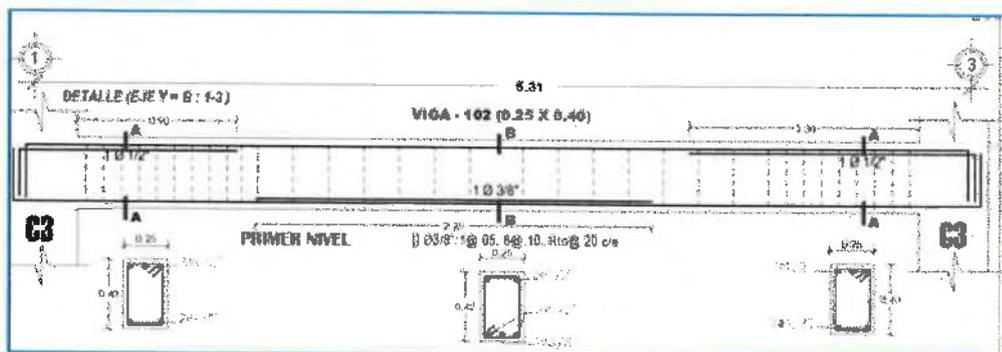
Detalle del acero de refuerzo de la viga-102, según expediente.
